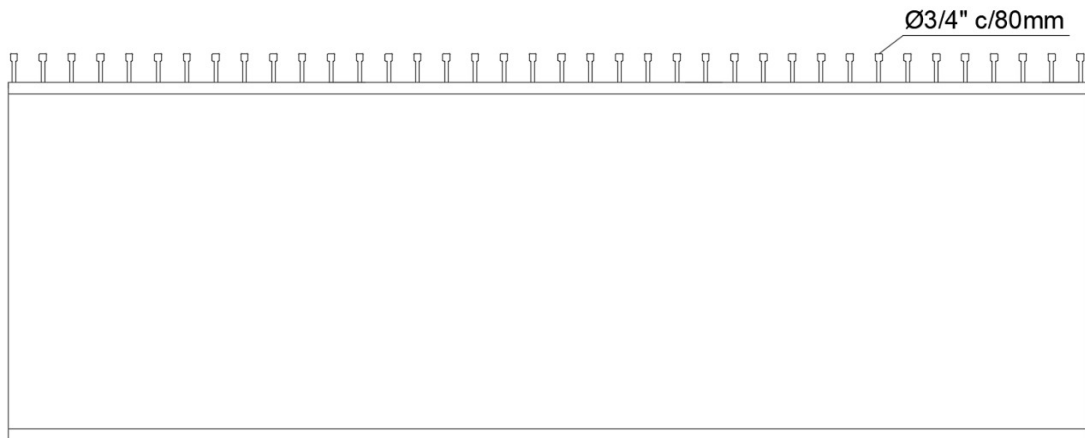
Vista lateral de la viga externa con los conectores de corte en su ala superior.
